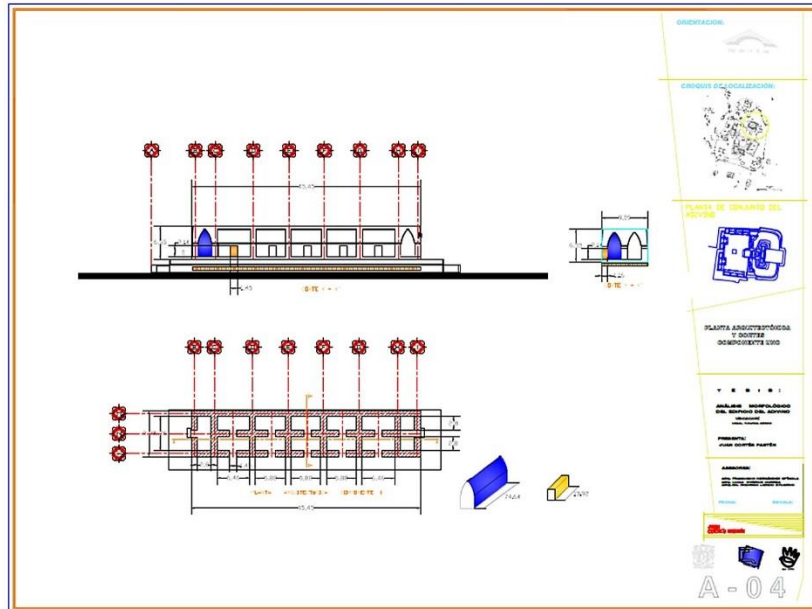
Cortés Juan. Planta arquitectónica y cortes del Componente uno. Planos arquitectónicos 04. 2016. Acervo J. Cortés.
